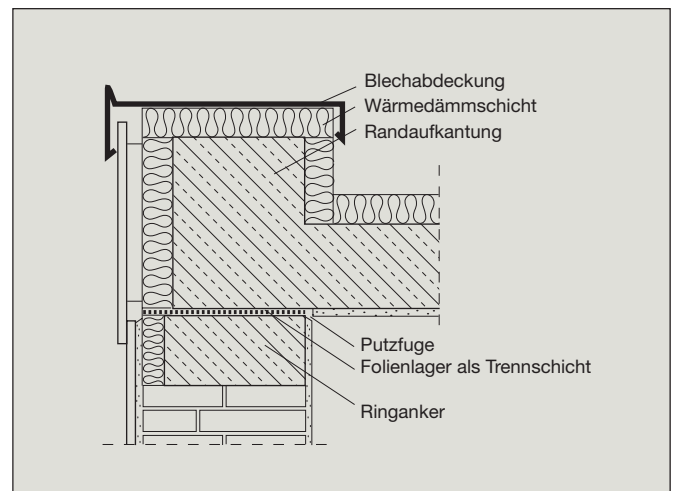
Auflagerung eines wu-Beton-Daches mit oberseitiger Dämmung auf Folienlager
